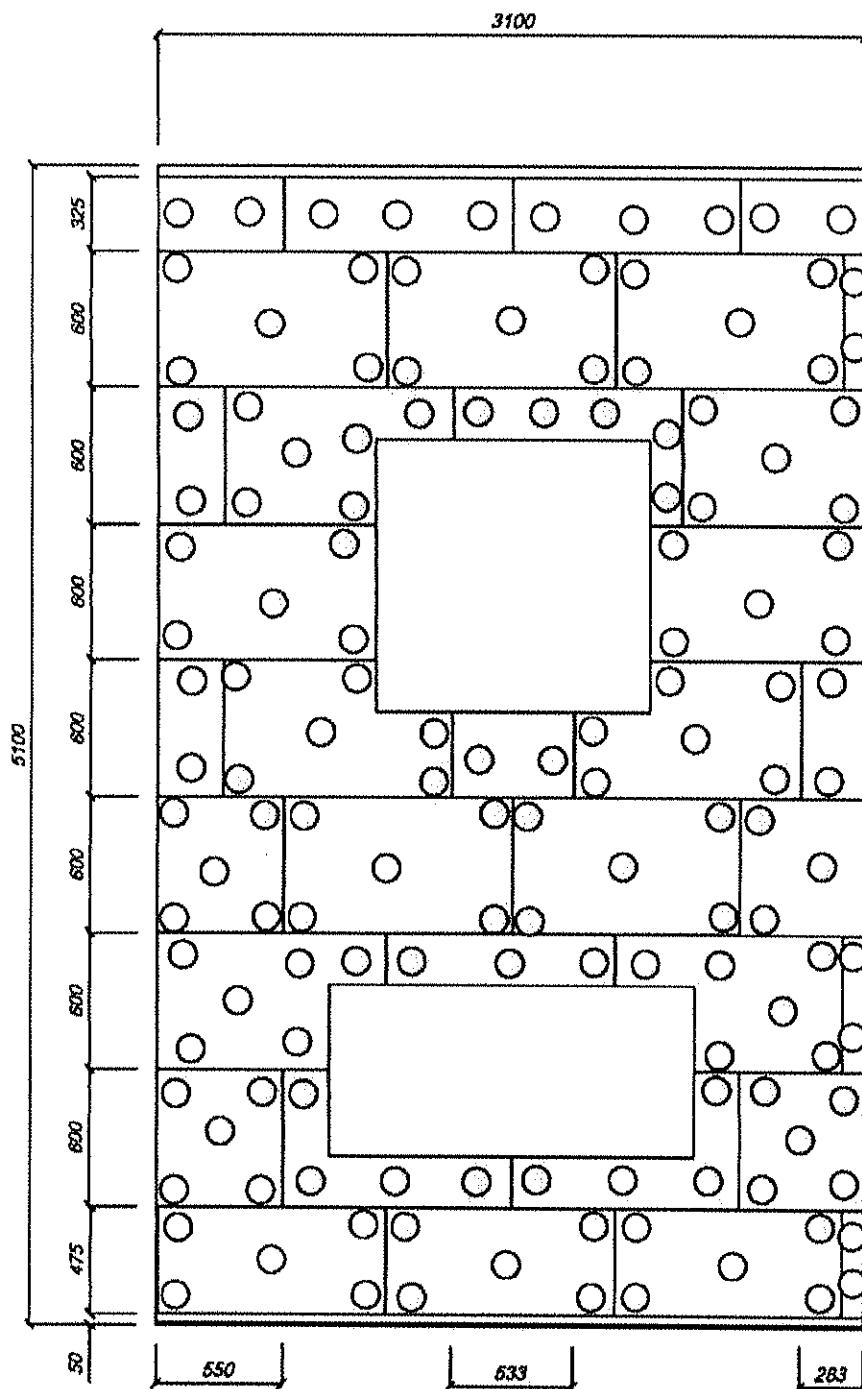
Схема расположения плит минераловатного утеплителя и тарельчатых дюбелей на фрагменте стене испытательной установки.
